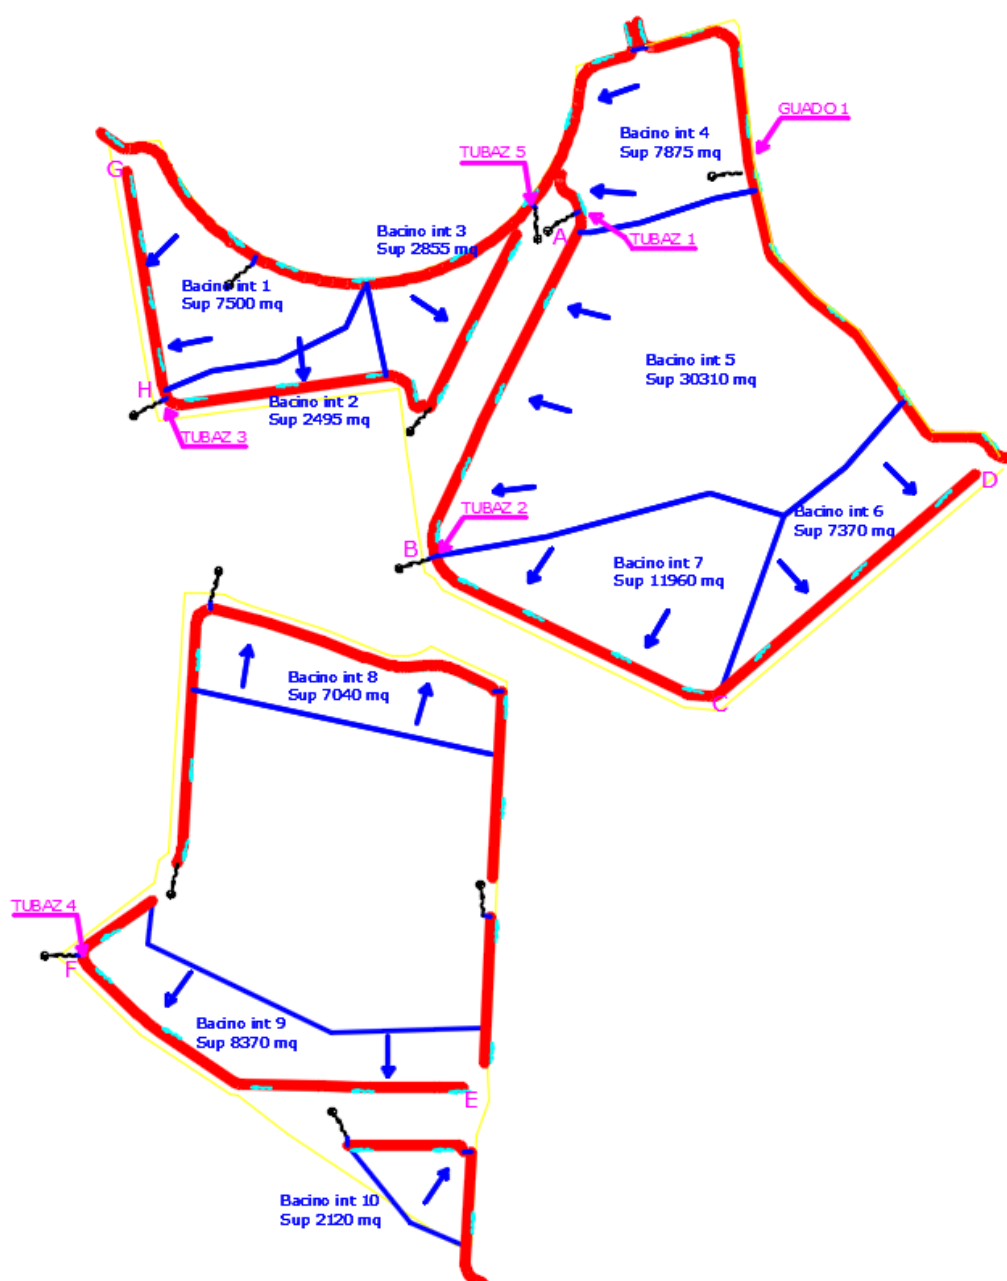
Planimetrie con individuazione dei tratti oggetto di verifica
